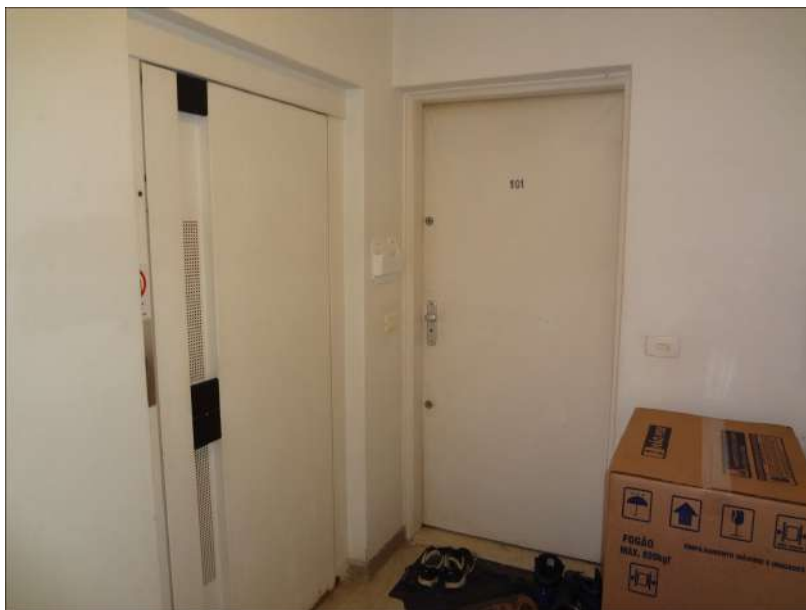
Elevador de serviço, hall de serviço e porta do apartamento 101.
